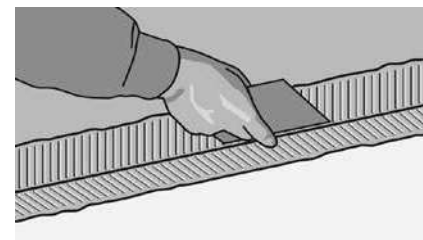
Используя прямой угол и карандаш, нанесите отметки на высоте 10 см по всей стене, где будет укладываться покрытие. Нанесите клей с помощью мелкозубчатого шпателя по всему периметру от низа стены до отмеченной линии там, где будет укладываться напольное покрытие. Нанесите некоторое количество клея на пол, как показано на рисунке.
